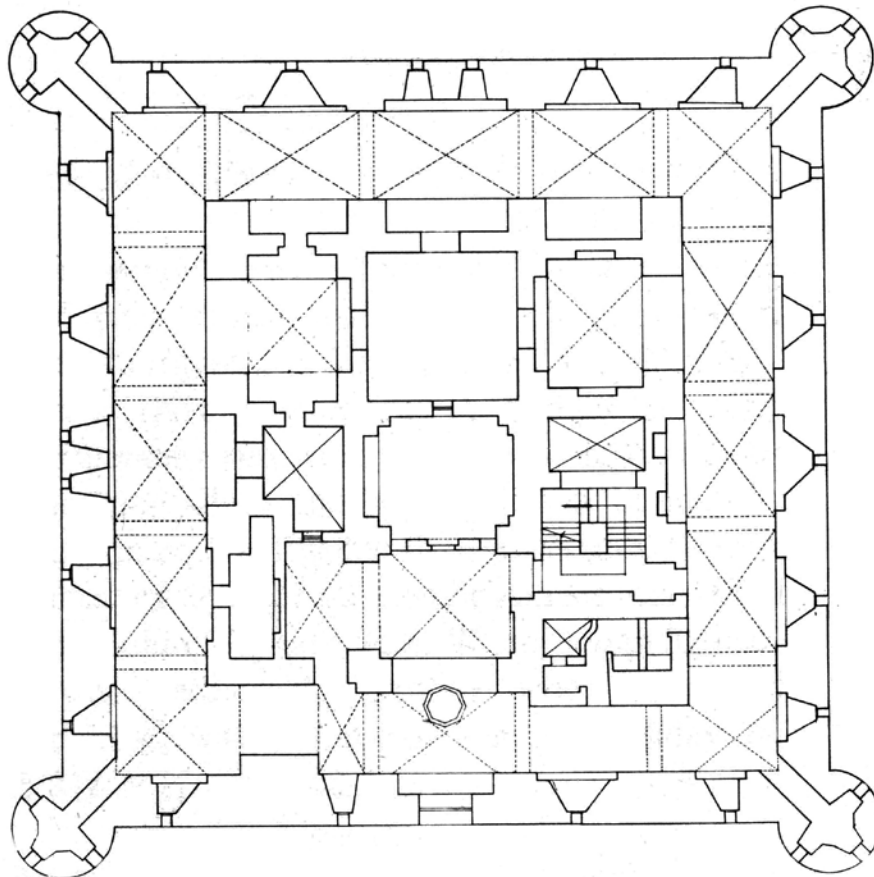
„A horizontal plan of the first floor“ (SAFWAT EL ALFY 1984).
